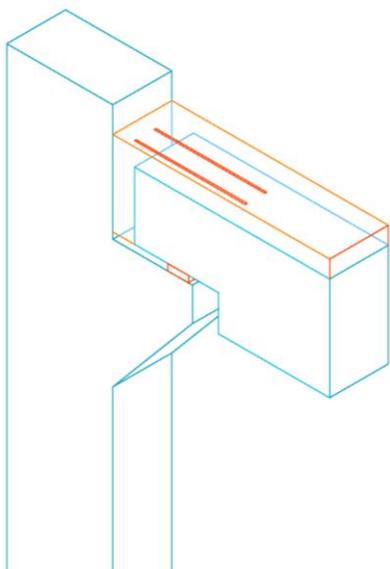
Encuentro entre una viga y un pilar de hormigón prefabricado. (Dibujo original)
